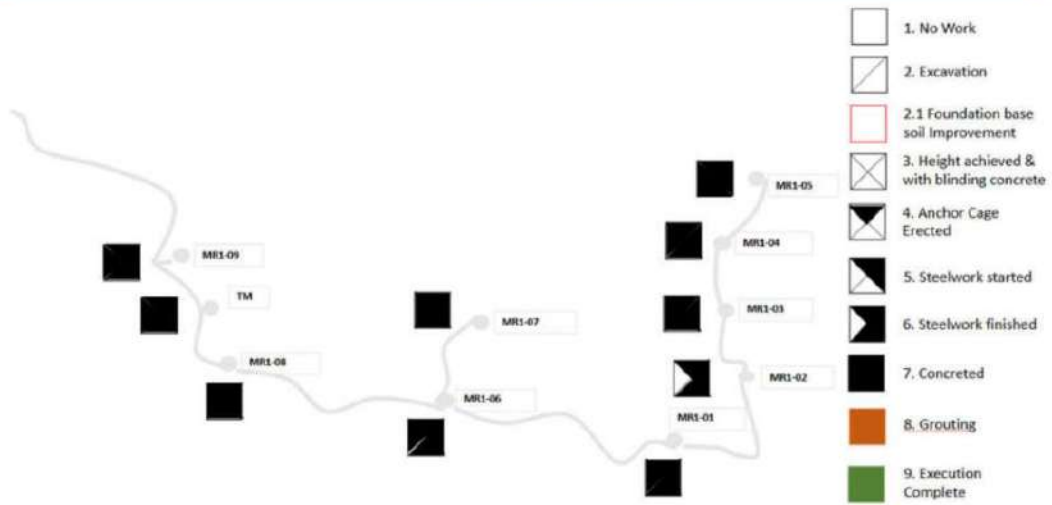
Estado y plano de obras ejecutadas a fin de mes.
